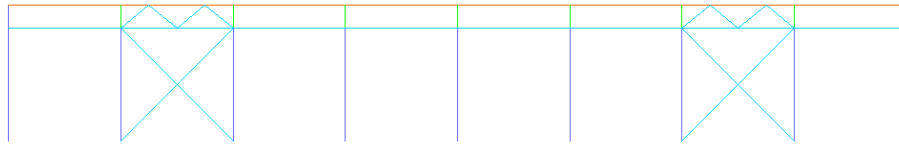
Contraventamento dos pilares metálicos, em “X”.
